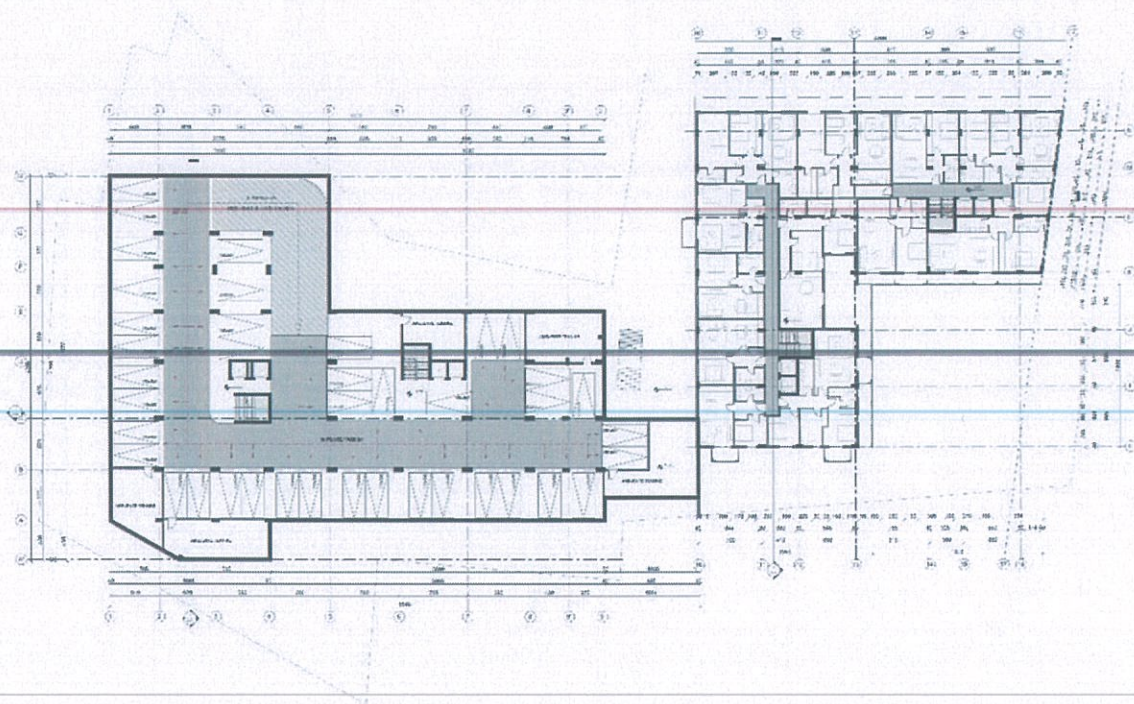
Plani i katit -1 2906.9 m² (banim dhe parkime)
